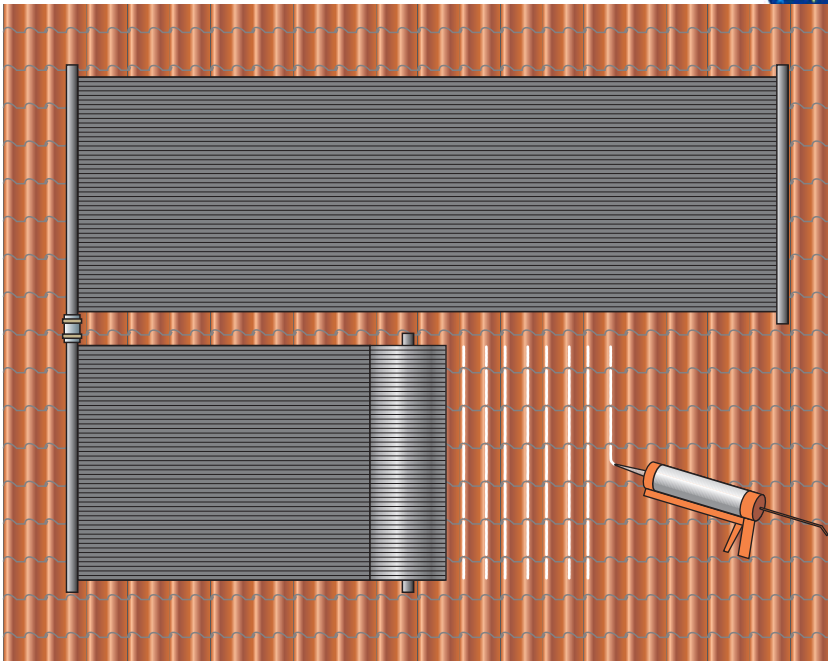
Fixation par collage de rouleaux de capteurs sur un toit de tuiles incliné
